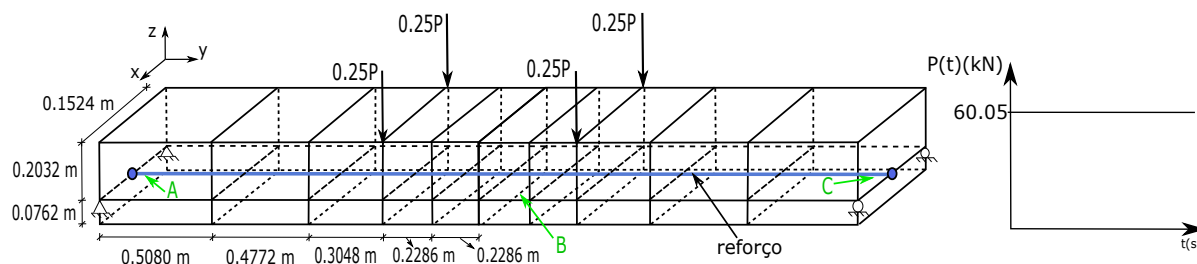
Viga de concreto armado sob carregamentos pontuais Bathe e Ramaswamy (1979).
